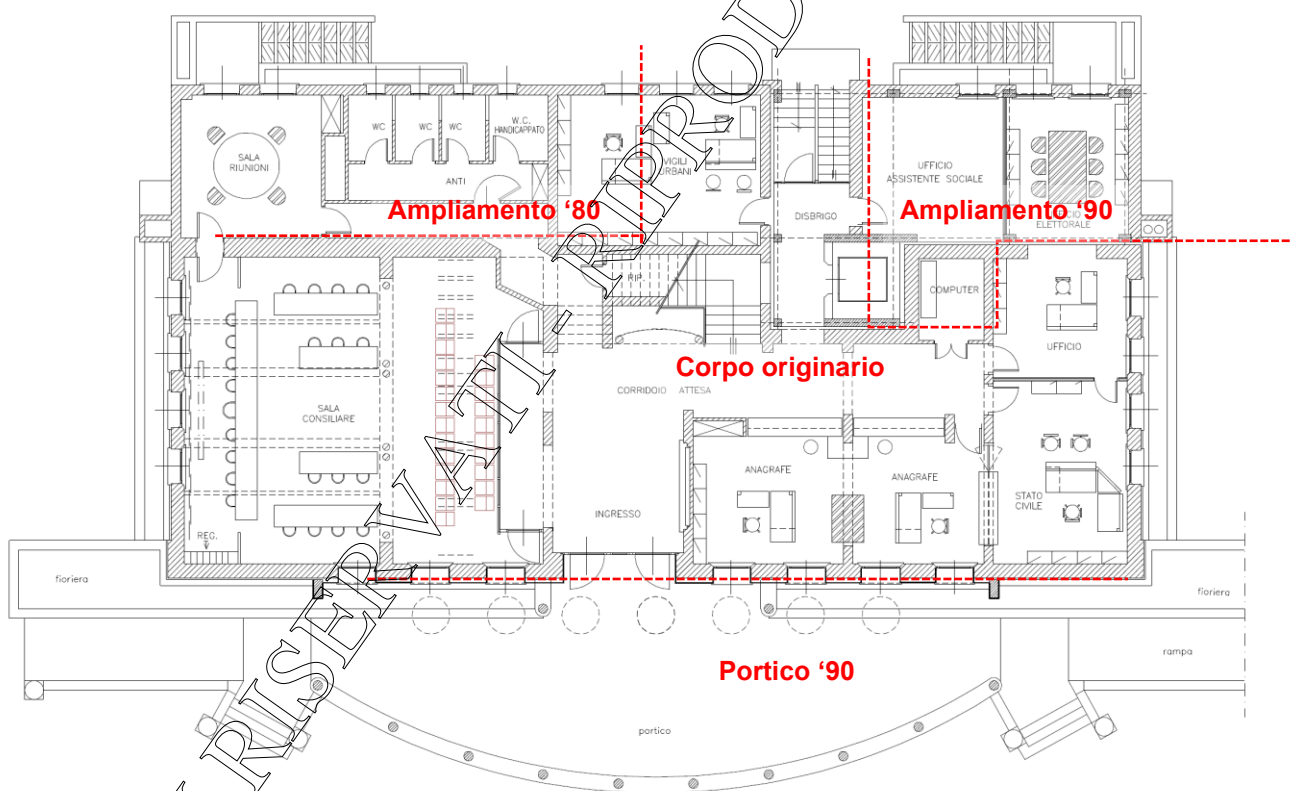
Pianta del piano terra con individuazione dei giunti di costruzione con linee tratteggiate rosse
